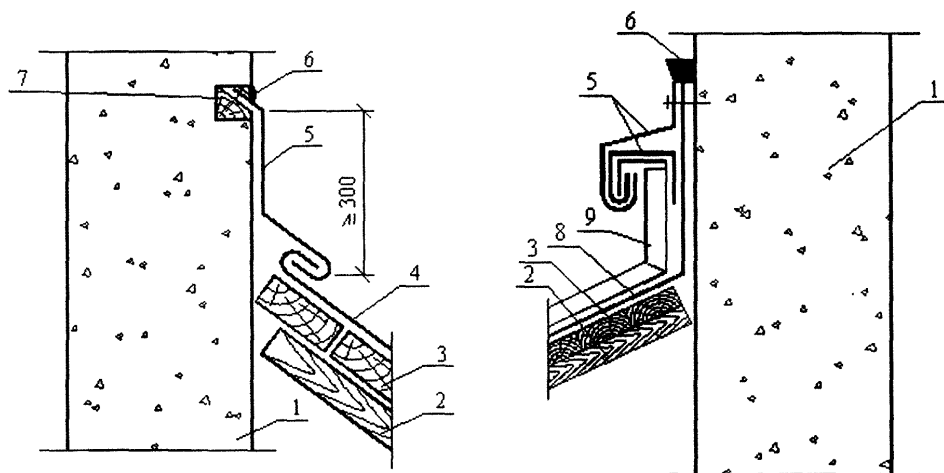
Примыкание кровли из листовой стали (а) и фальцевой кровли из медных листов (б)
